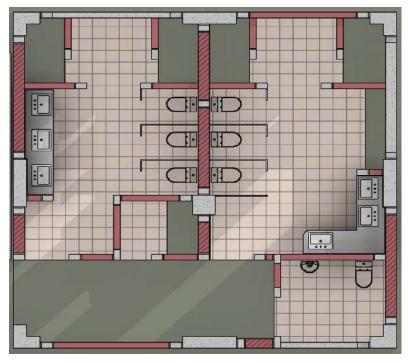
Modelo BIM, Vista en Planta del Primer Nivel del Módulo B.
